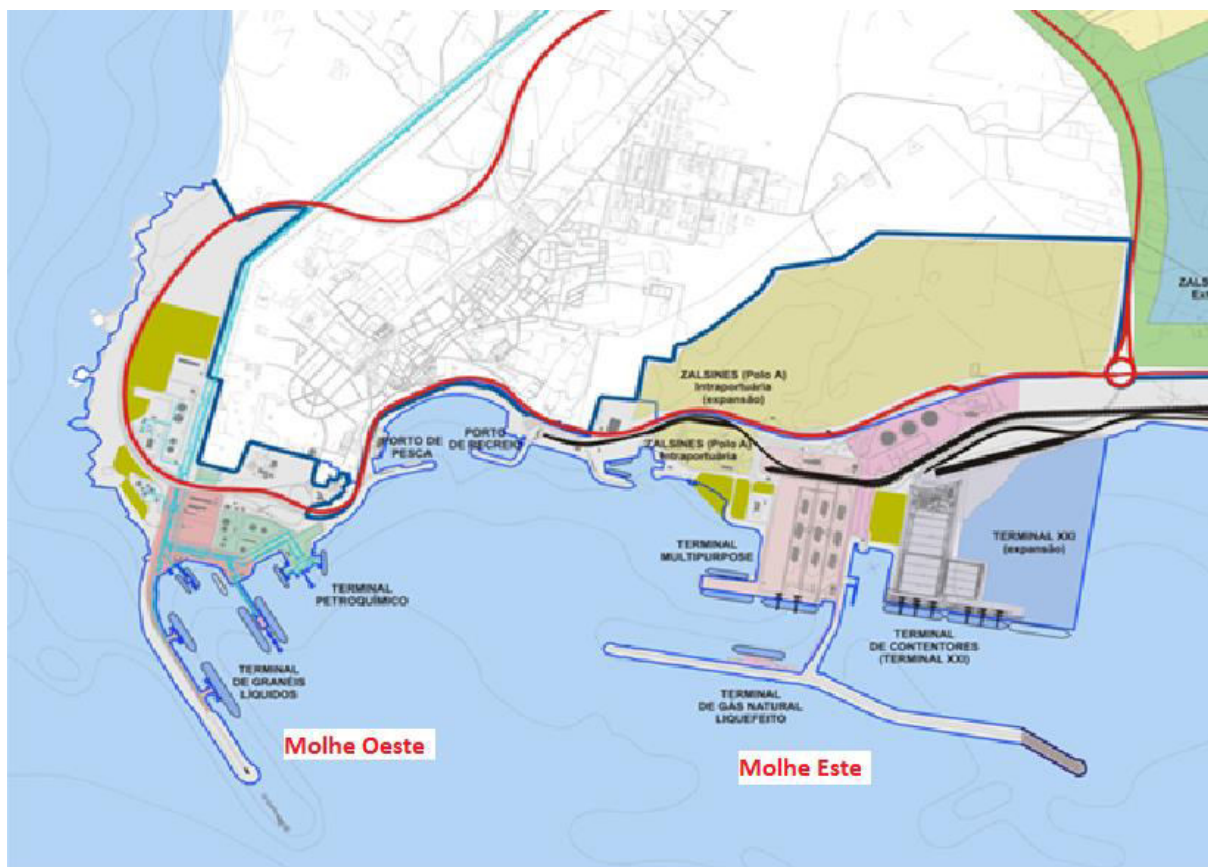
Planta do complexo portuário de Sines (Fonte: APS)
